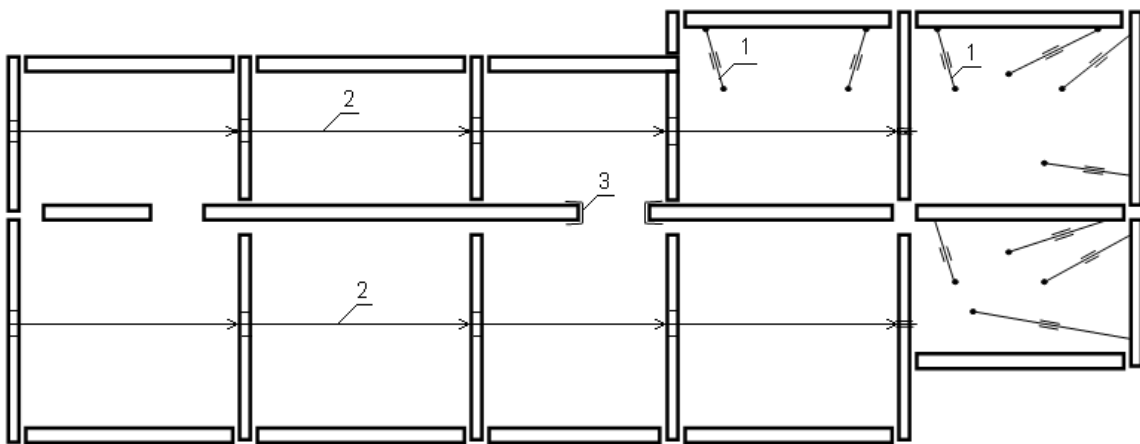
Временное крепление стеновых панелей: 1 – подкосы;
